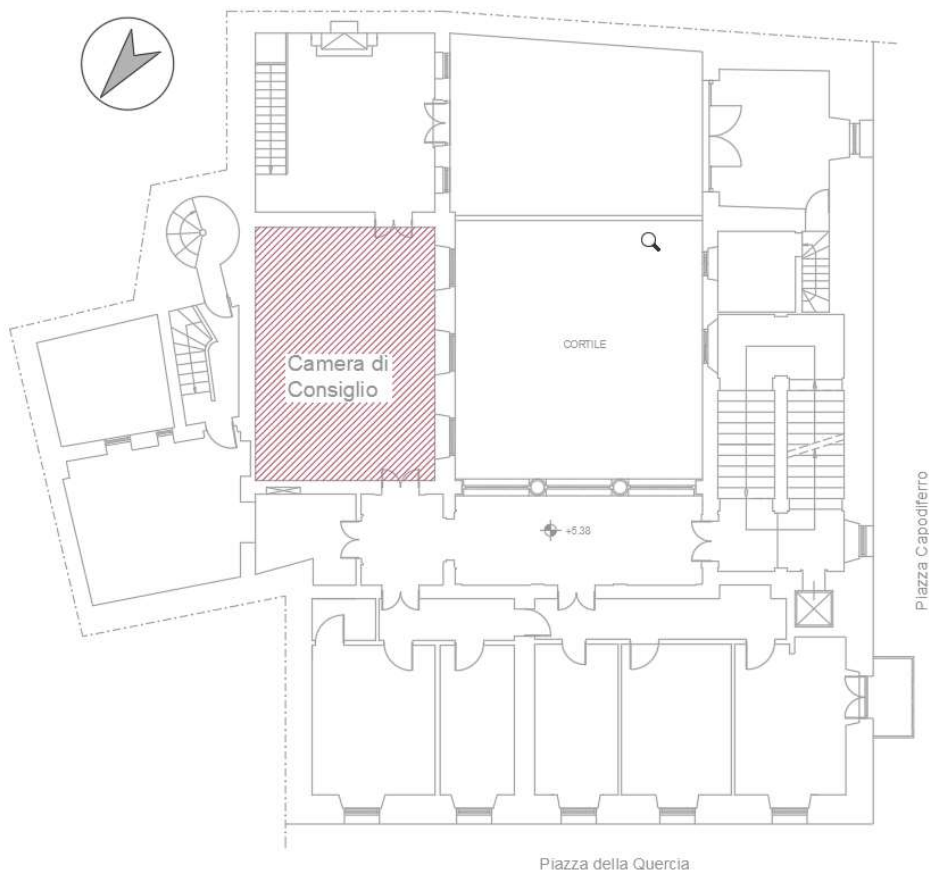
Planimetria piano primo Palazzo Ossoli: Camera di Consiglio
